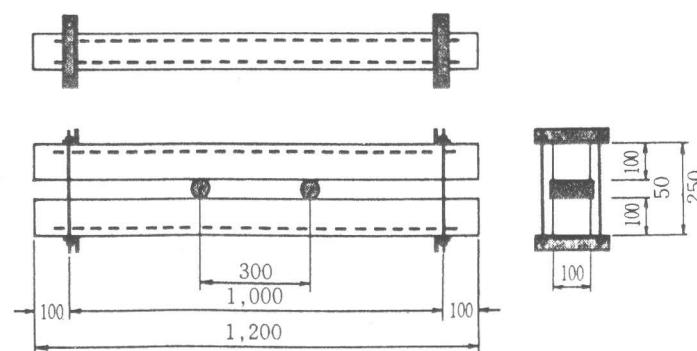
試験体の寸法と締めつけ方法 (単位:mm)
